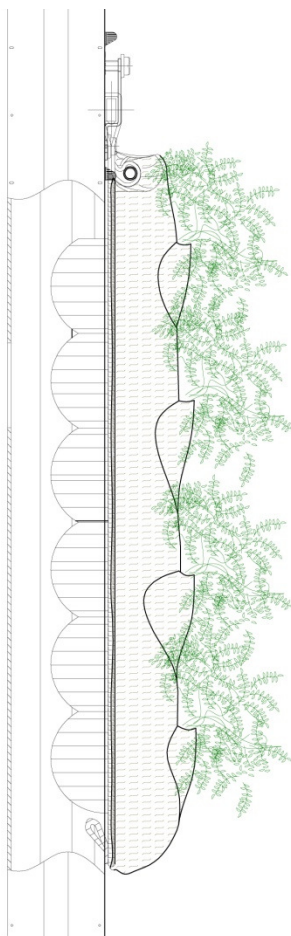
Vista prospettica e sezione dell'aggancio dei moduli di verde naturale.
